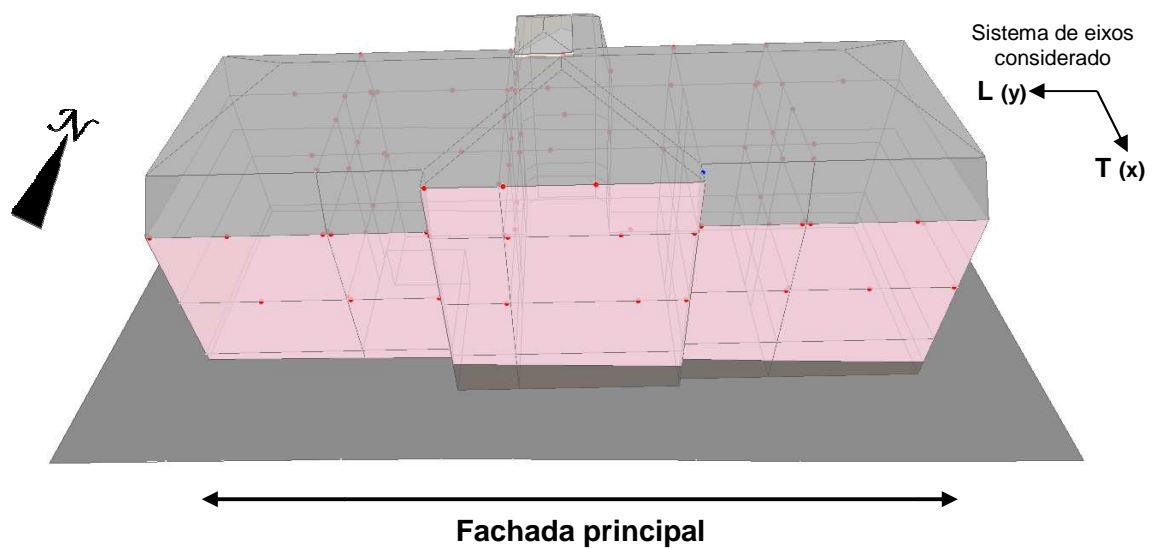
Visualização tridimensional da estrutura em estudo, pontos de medição e orientação do sistema de eixos considerados na implementação sensores nas direções longitudinal (L) e transversal (T).
